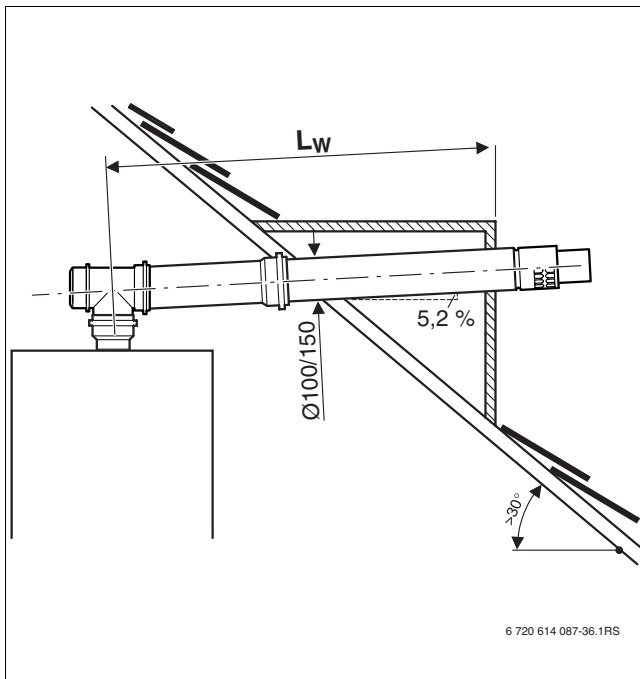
Doppelrohrführung waagrecht ($C_{33(x)}$)
